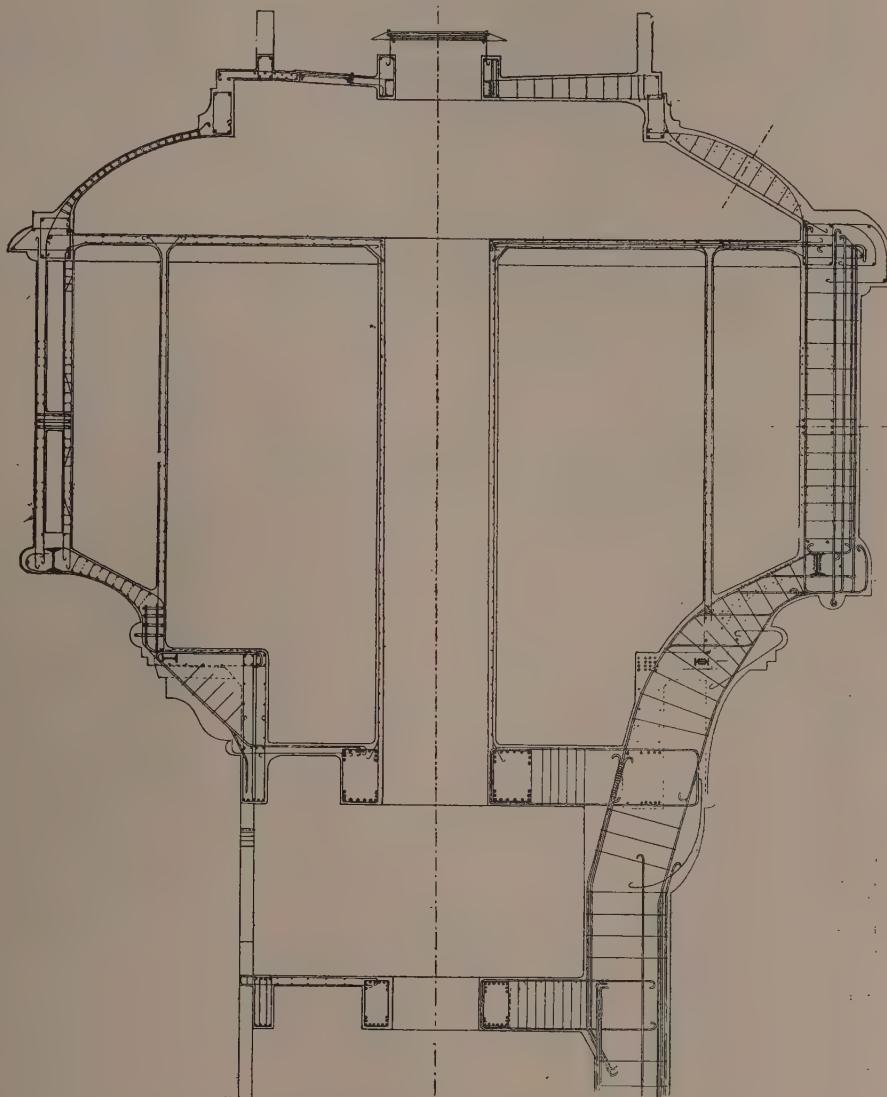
PARTICOLARE DELLE ARMATURE DELLA VASCA DEL SERBATOIO ELEVATO DI VILLAFRANCA DI VERONA
